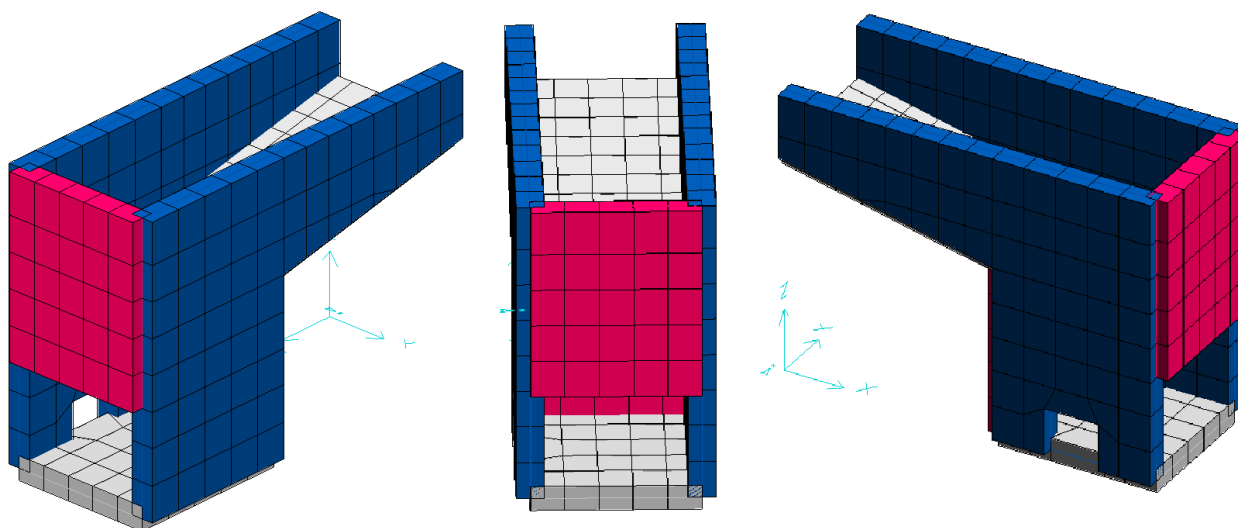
Manufatto di imbocco – modello FEM – a SX assometria lato sinistra idraulica, al centro vista prospettica frontale, a DX assometria lato destra idraulica
